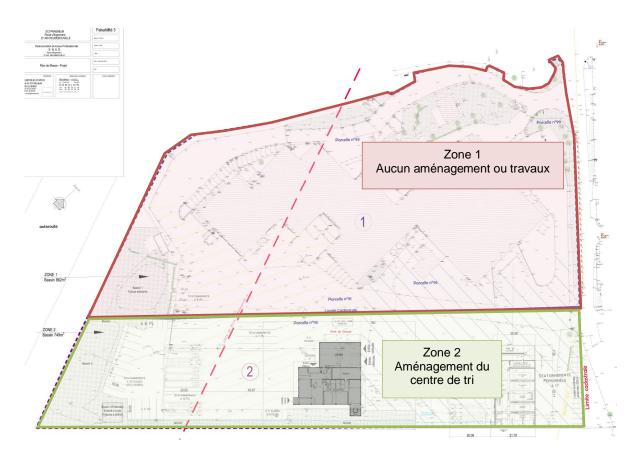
Plan de zonage de la gestion des eaux pluviales
